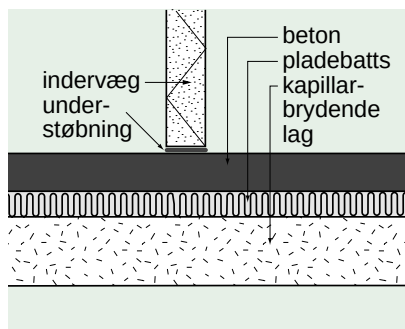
En etagehøj, 75 mm tyk indervæg af porebeton placeret på gulv med stabiliserende understøbning.
